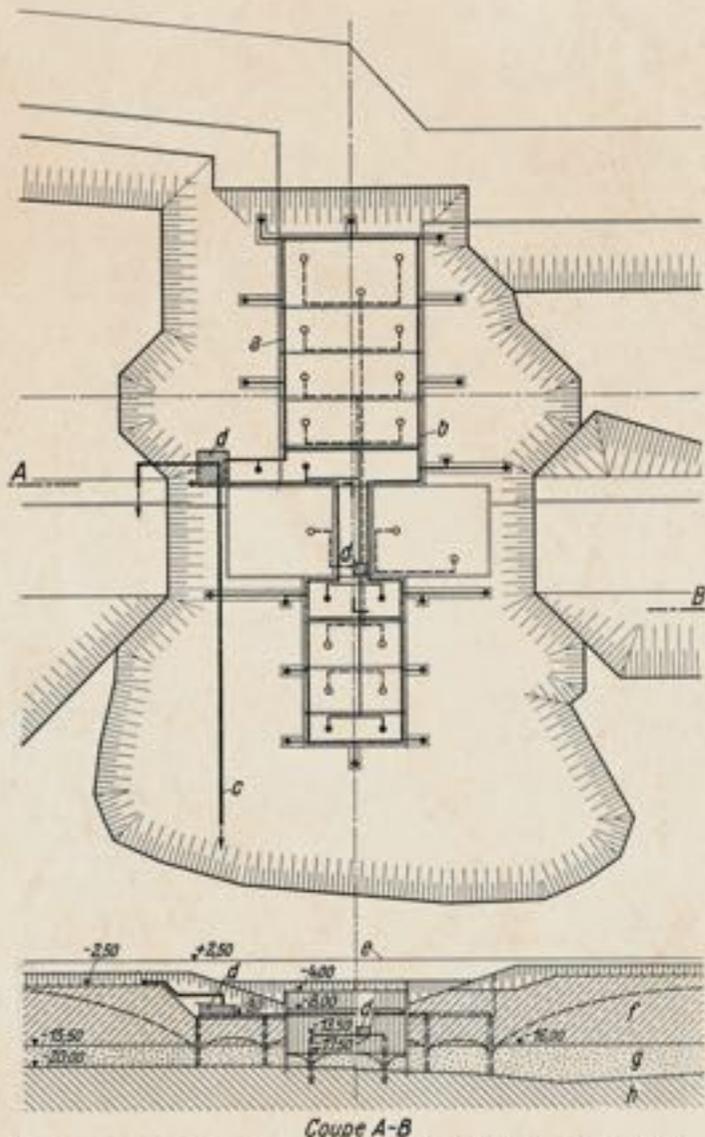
Plan de situation de l'installation définitive de rabattement à la tête aval. a. Palplanches Larssen ; b. Conduites d'aspiration ; c. Conduites de refoulement ; d. Station de pompage ; e. Niveau de la nappe abaissée ; f. Kéi ; g. Sable ; h. Argile compacte.
